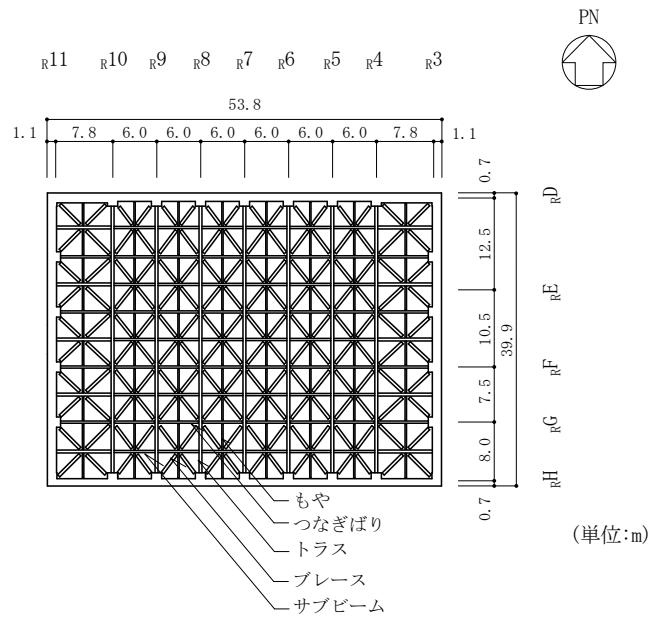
(9) 原子炉建物の概略平面図 (EL 63.5m)
